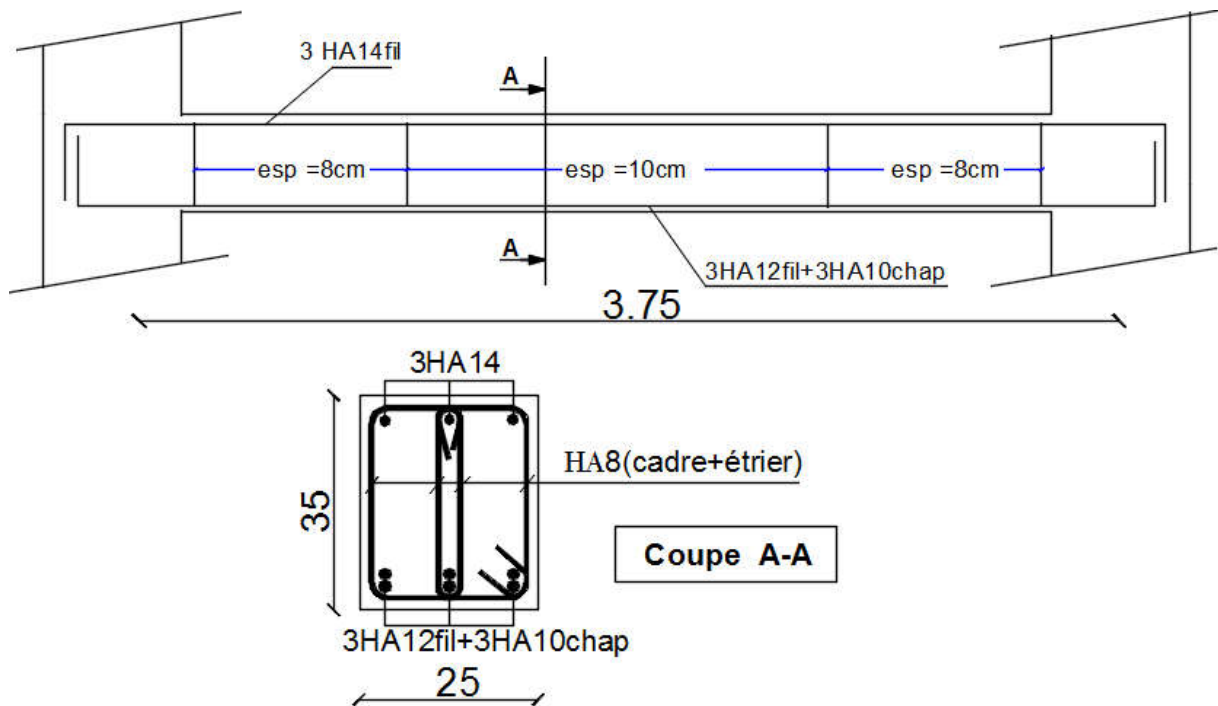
Schéma de ferrailage de la poutre palière.
